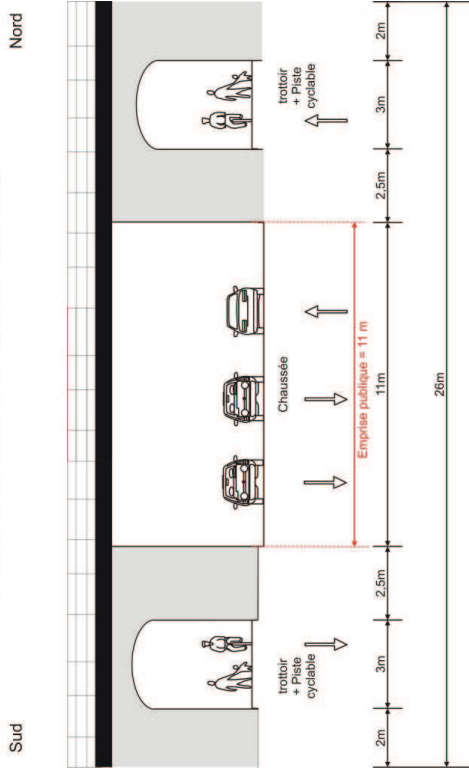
Situation existante coupe 32 sur la rue de Koenigshoffen
